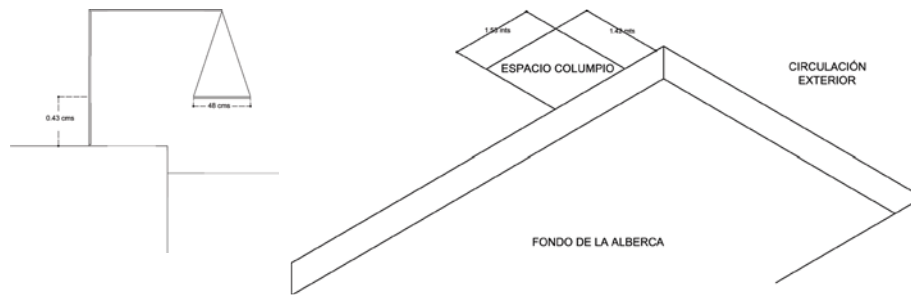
Columpio para descender. IMAGEN 49 Detalle de rampa
